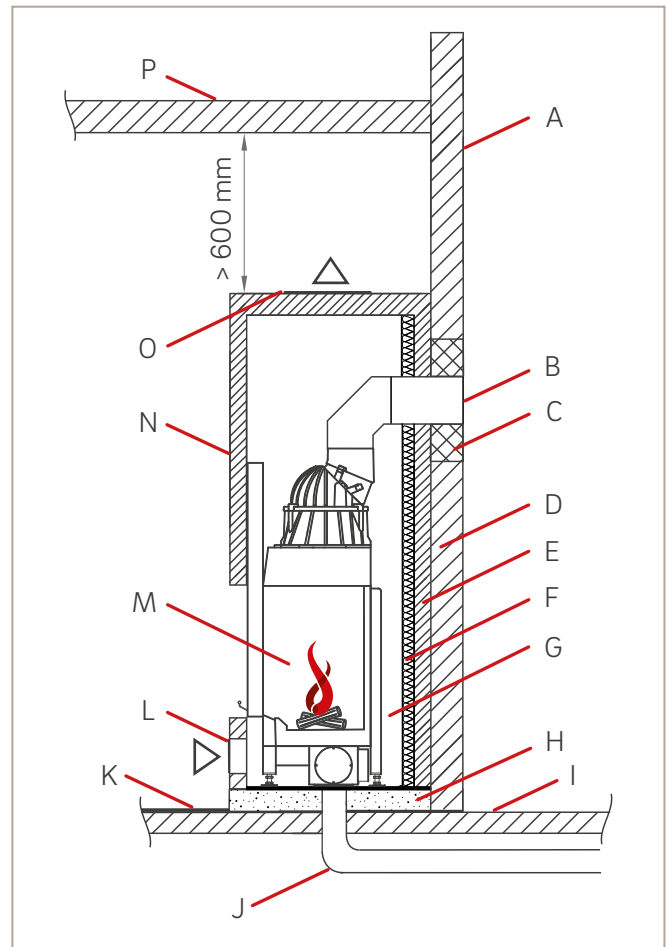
Einbaubeispiel für eine Systemanlage vor zu schützenden Wänden, Böden, Decken
